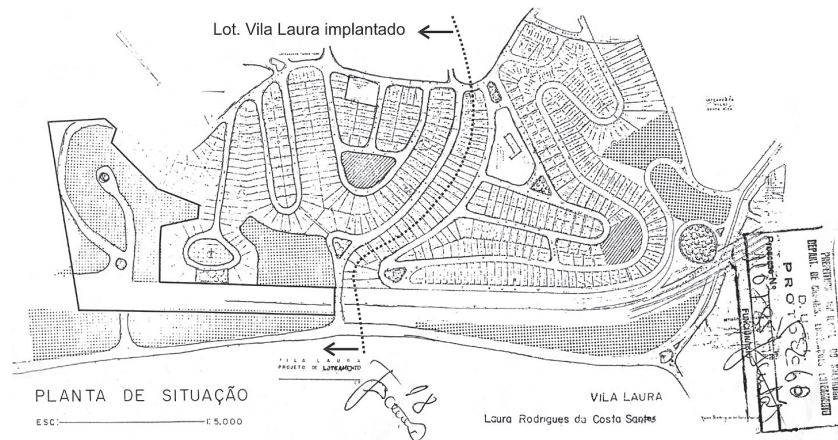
Planta de Situação do Loteamento Vila Laura. Fonte: SCT/SUCOM/PMS
